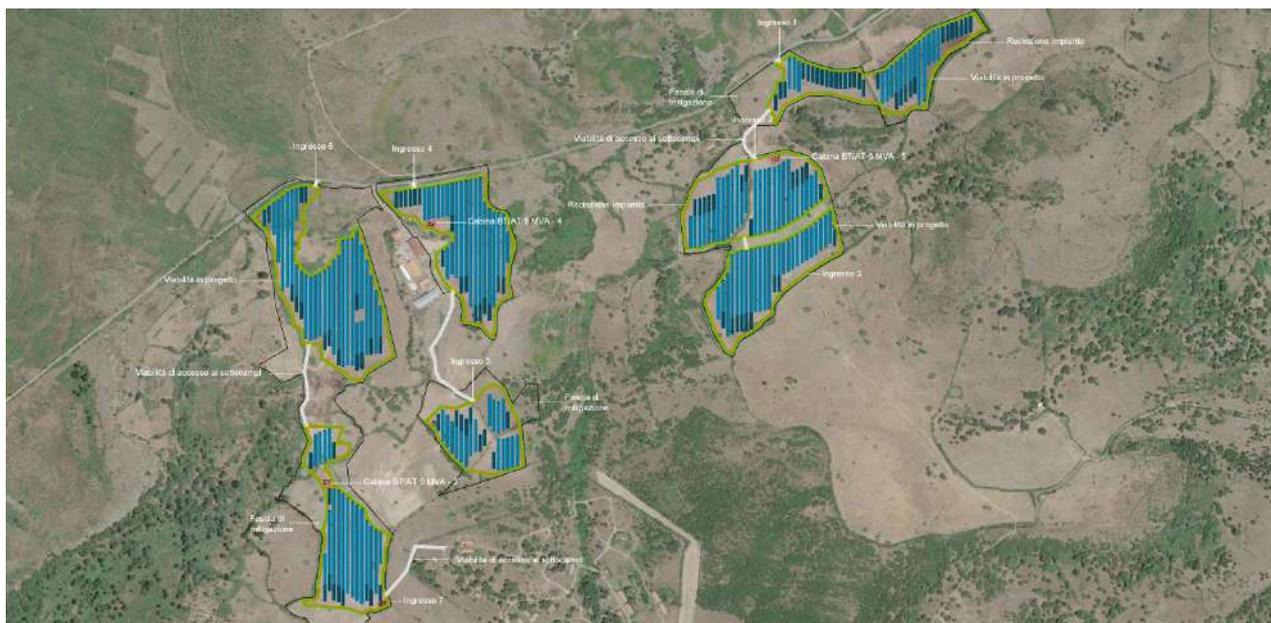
LAYOUT PLANIMETRICO CON VIABILITÀ DI COLLEGAMENTO TRA I SOTTOCAMPI (IN BIANCO) AGGIUNTA (SINDIA2-PDT05-R1)
